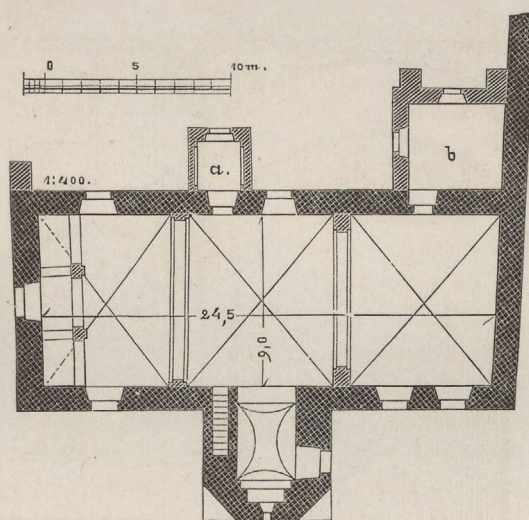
Krojanke. Grundriss der kath. Kirche.
